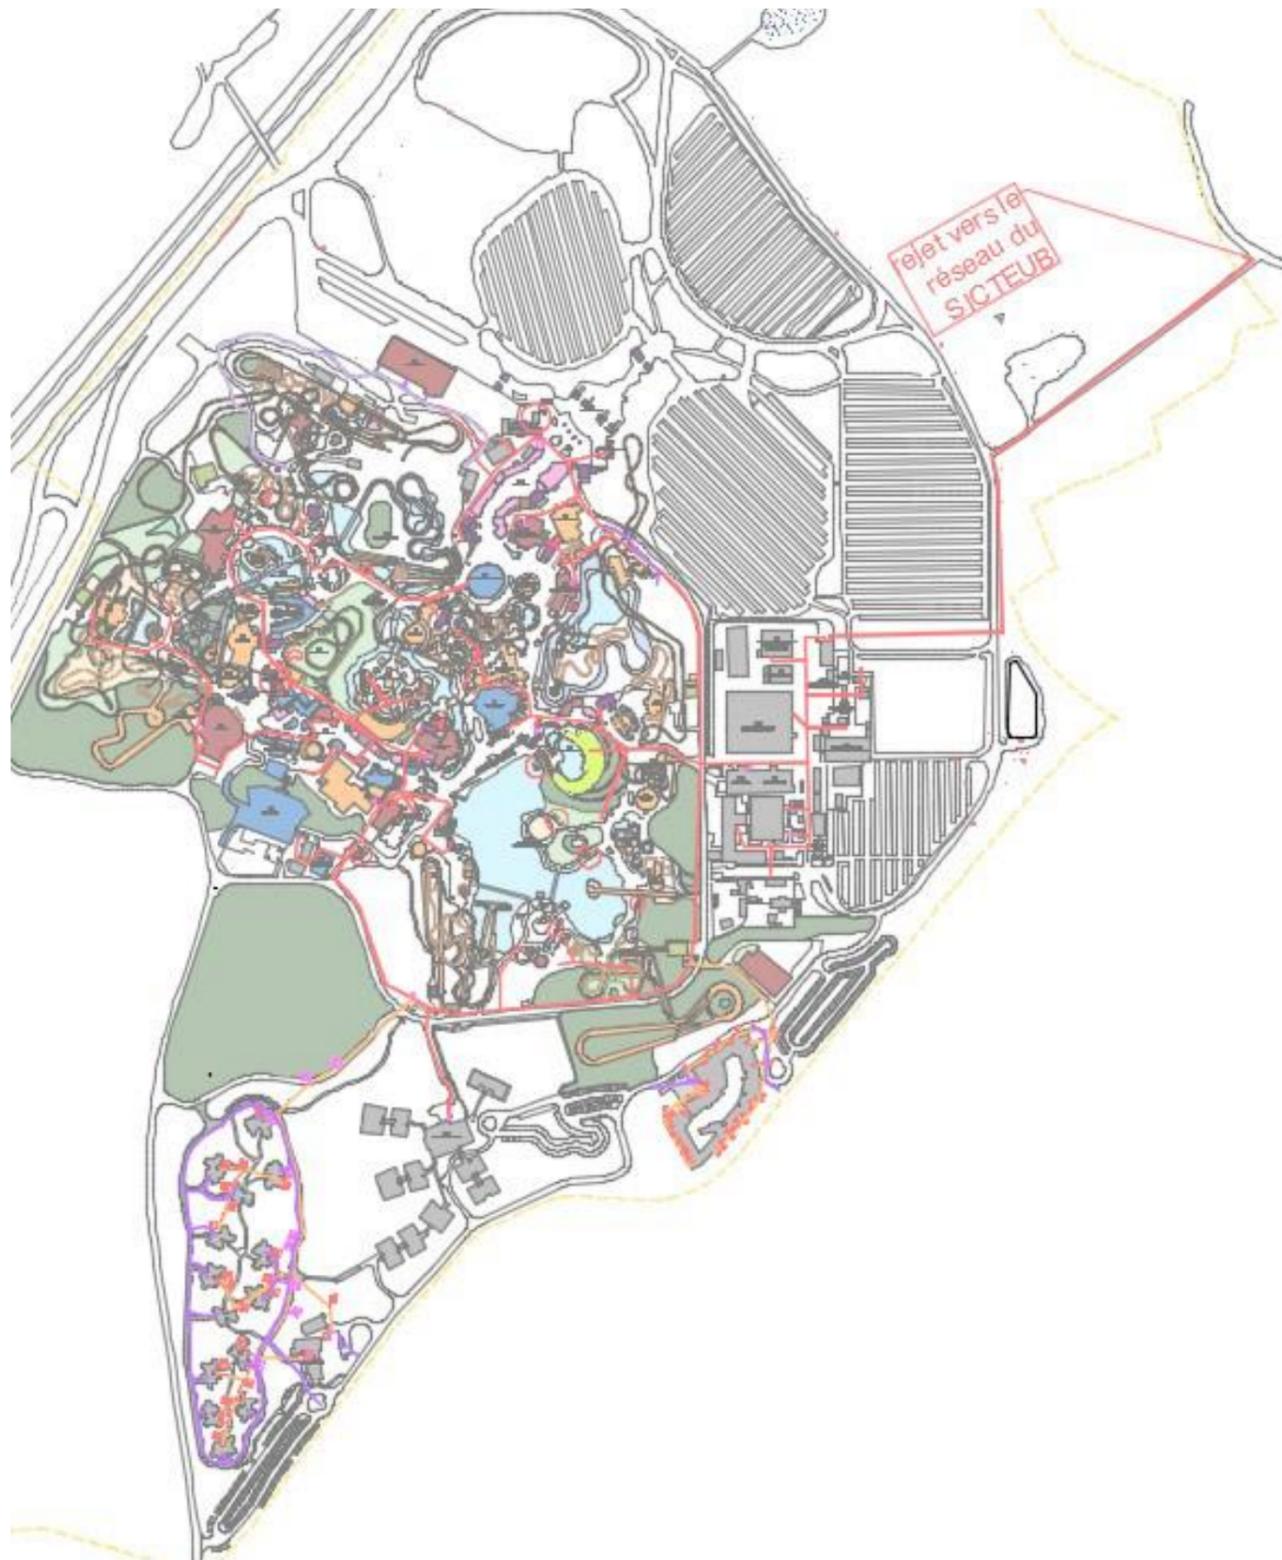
Plan du réseau des eaux usées (Parc Asterix)
